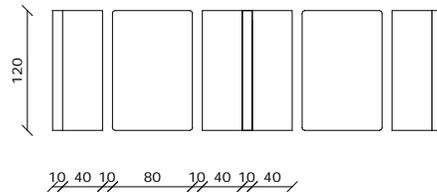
ELEVACIÓN LATERAL DE LOS COMEDORES.
